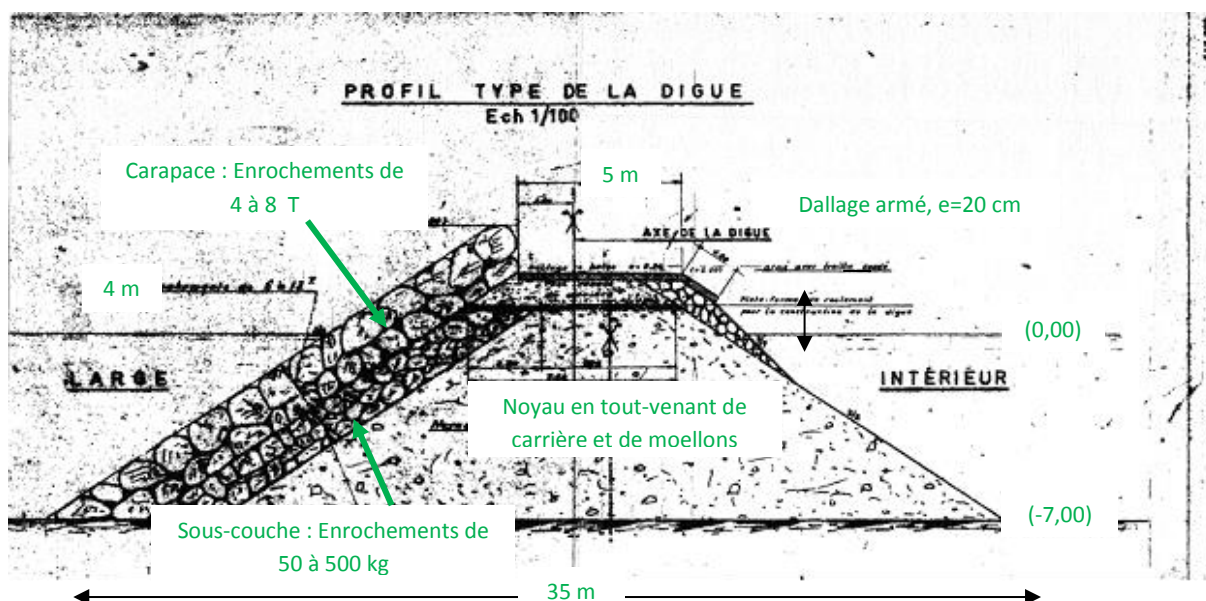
coupe théorique en B-B de la digue de protection du plan d'eau (voir la position sur le plan masse sur la figure 4)
